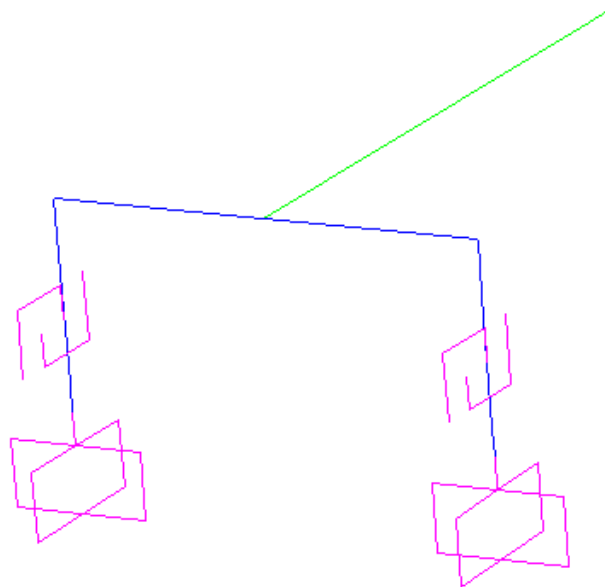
Dettaglio della modellazione dei dispositivi longitudinali nella spalla;
